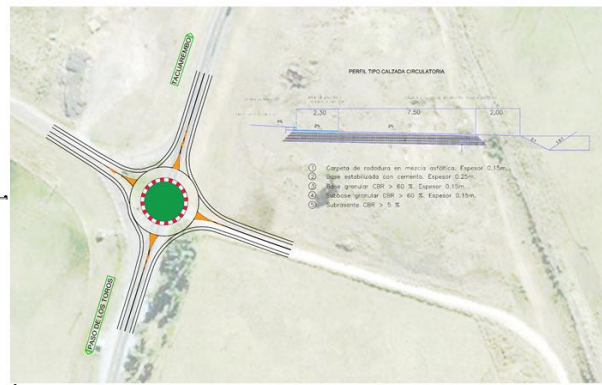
Perfil transversal de la plataforma Tramo 1
